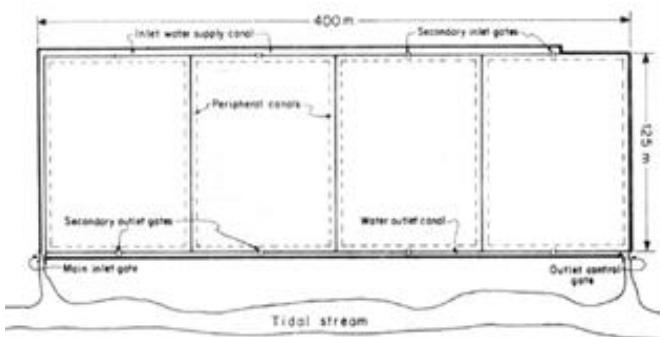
Alternatif pemilihan alternatif inlet dan Outlet
